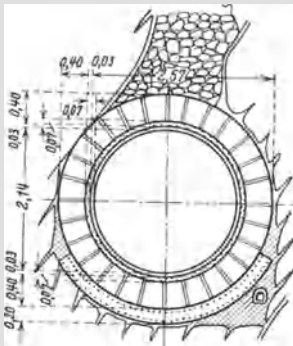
Stollenquerschnitt an einer Einbruchstelle von Sand. Maßstab 1 : 115.
